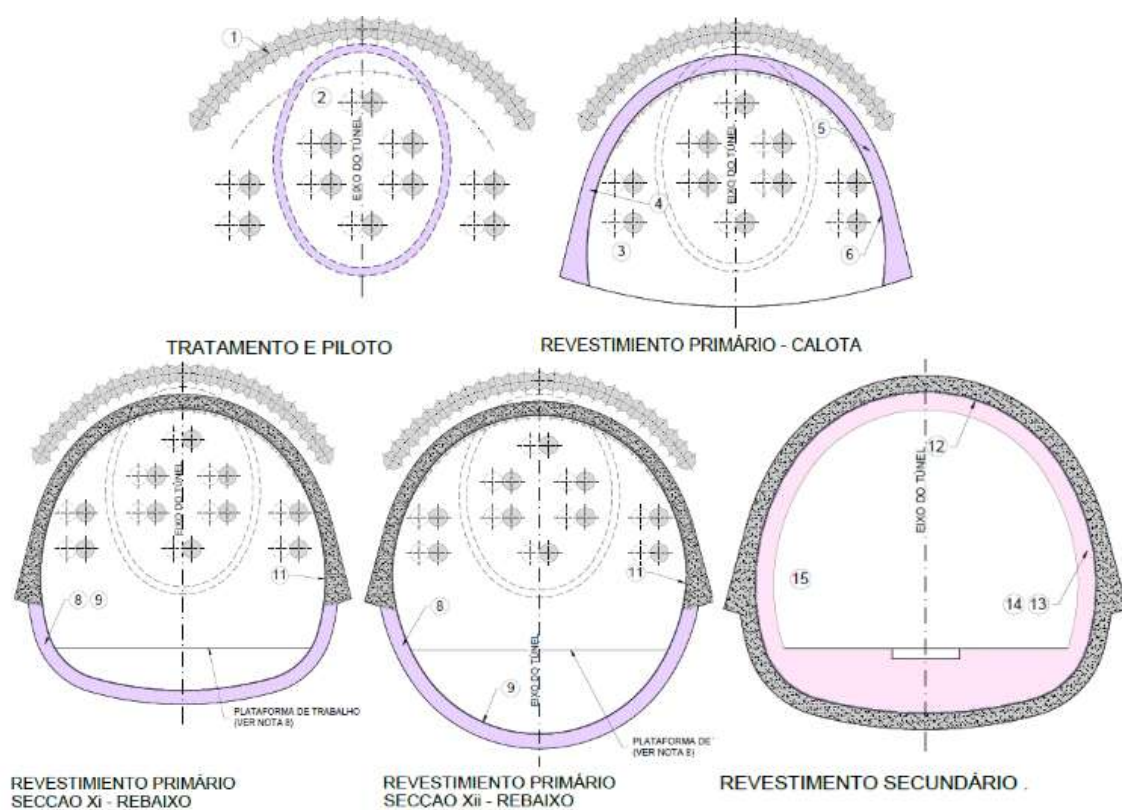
Sequência de construção do Túnel de Ligação 1 (excerto de documento de projeto).
